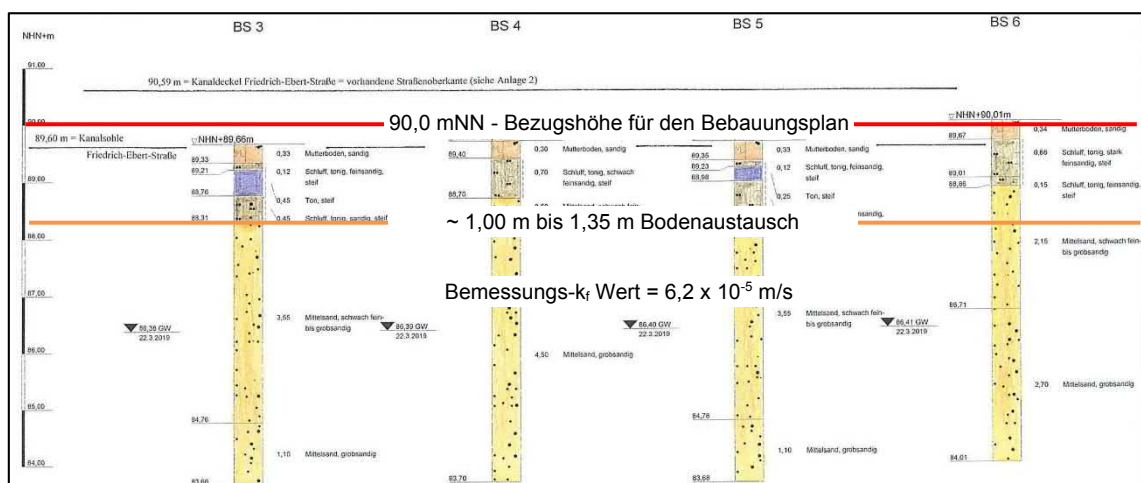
Bohrprofile BS 3 bis BS 6 [Glafe] inkl. Bodenaustauschhorizont und k_f -Wert untere Schichten [Glafe]
